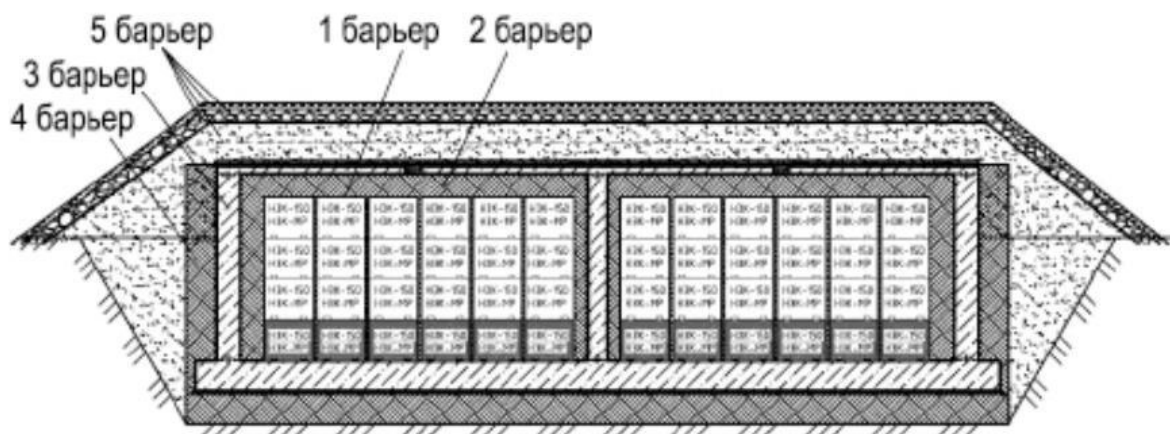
Параметры бетонных стен модульного сооружения ППЗРО при использовании бетона класса В30. 3 барьер (ИББ3): бетонные стены - 800 мм, основание - 1000 мм, верхнее перекрытие - 250 мм [54].
